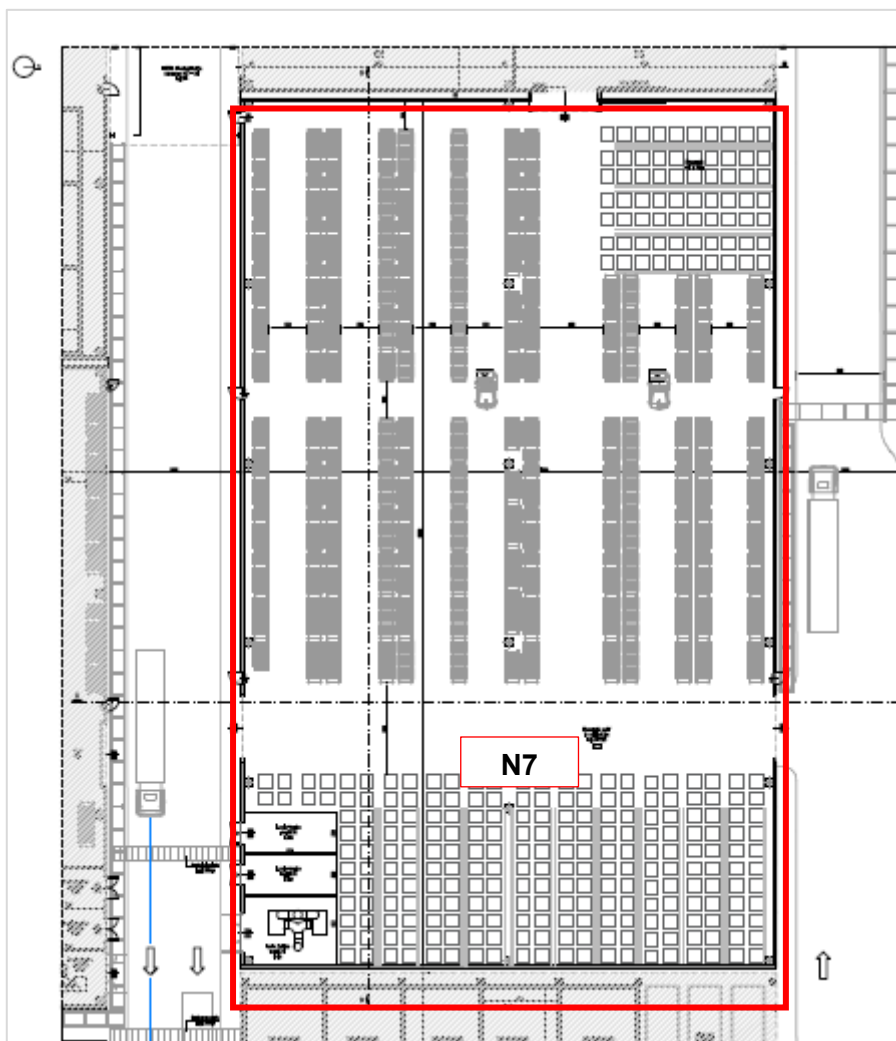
Dettaglio localizzazione Sezione N7 (Stralcio elaborato CO 05 RA VA 01 D1 PL 62.00 - N7 PIANTE)
